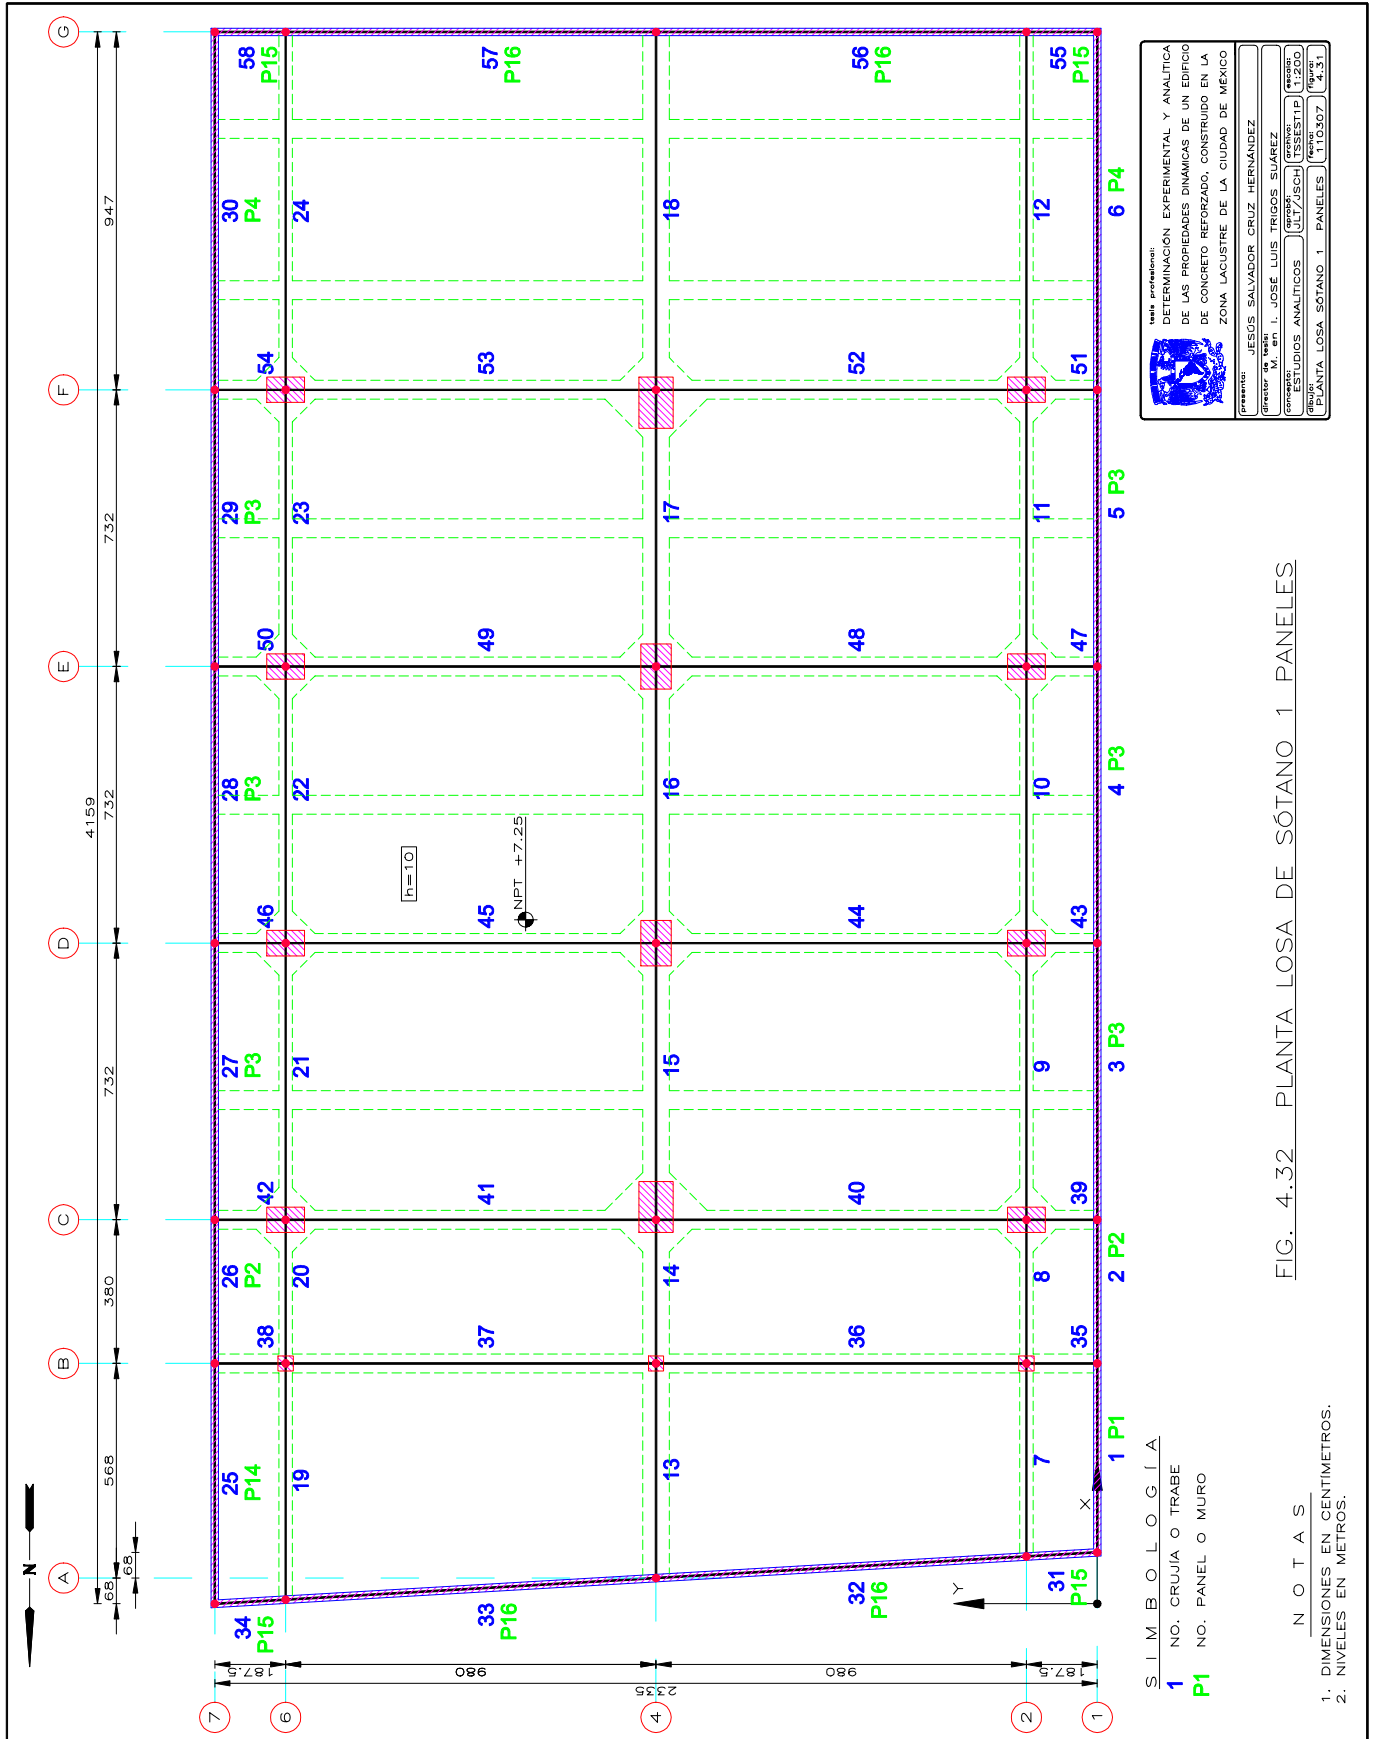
PLANTA LOSA DE SÓTANO 1 PANELES
